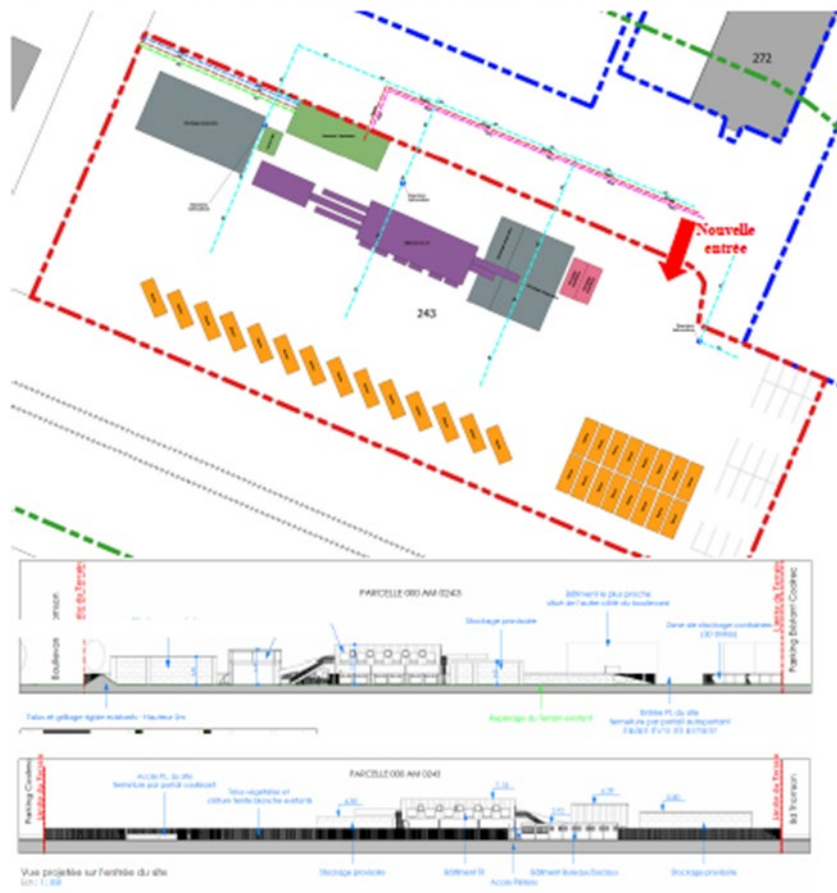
Plan d'implantation de la nouvelle ligne de traitement des PAM (vue en plan en coupe)
